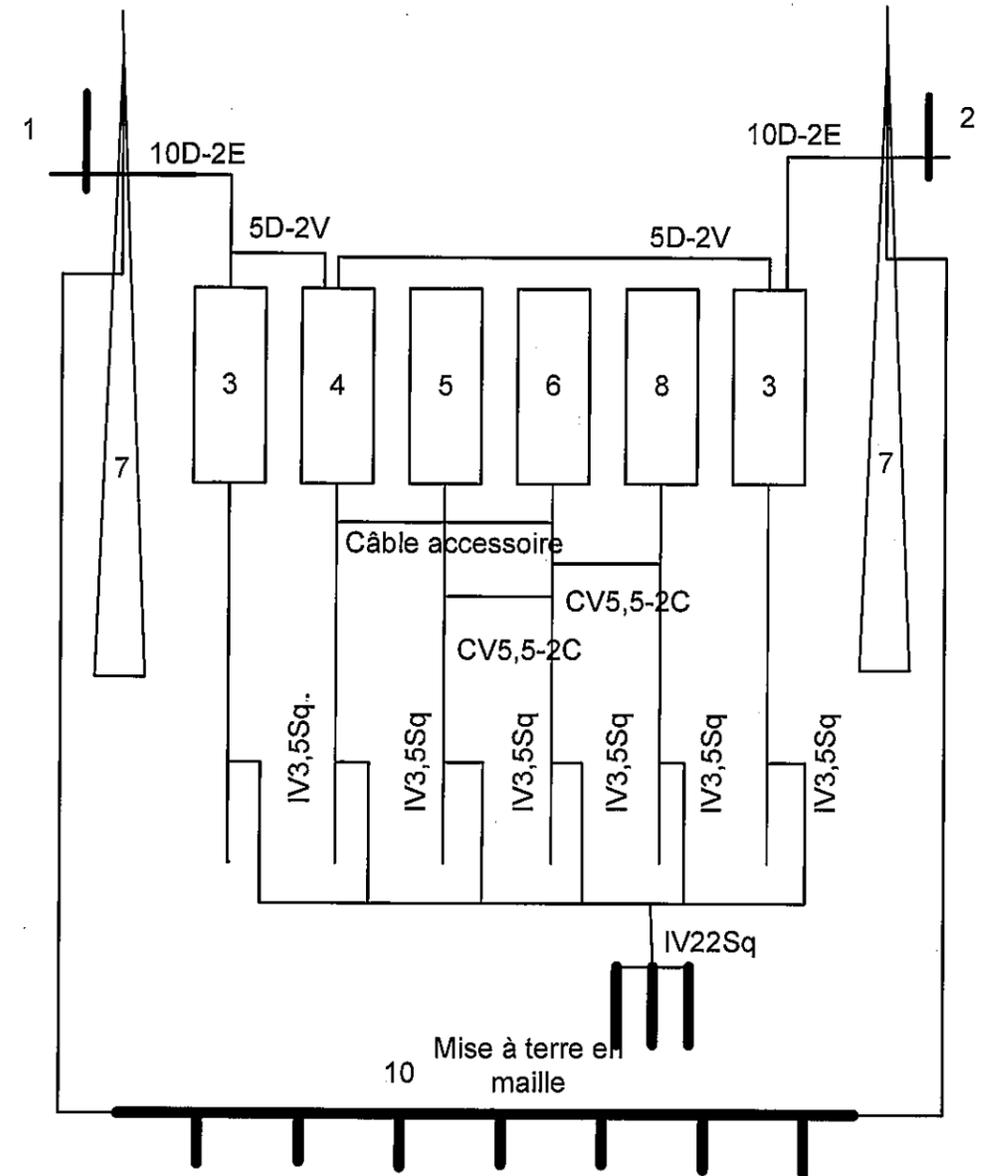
(2) PLAN DE SITUATION ET DE CABLAGE
